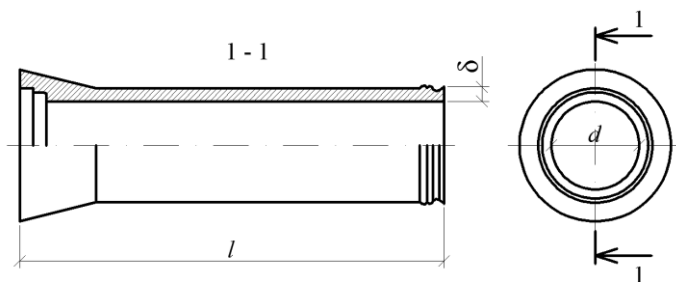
Труба железобетонная безнапорная раструбная типа ТБ
